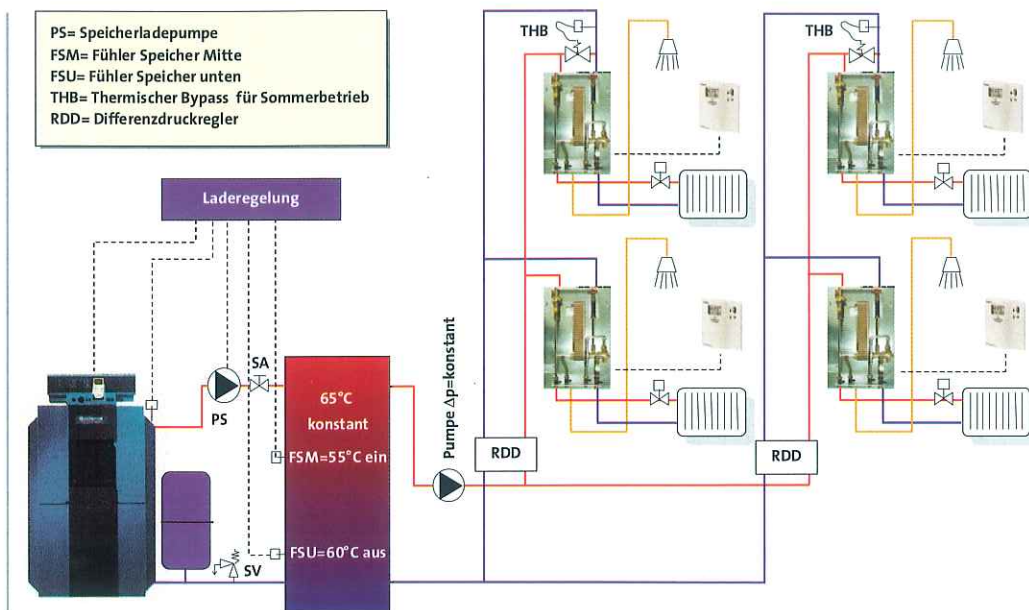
Hydraulisches Gesamtsystem der Etagenstationen
